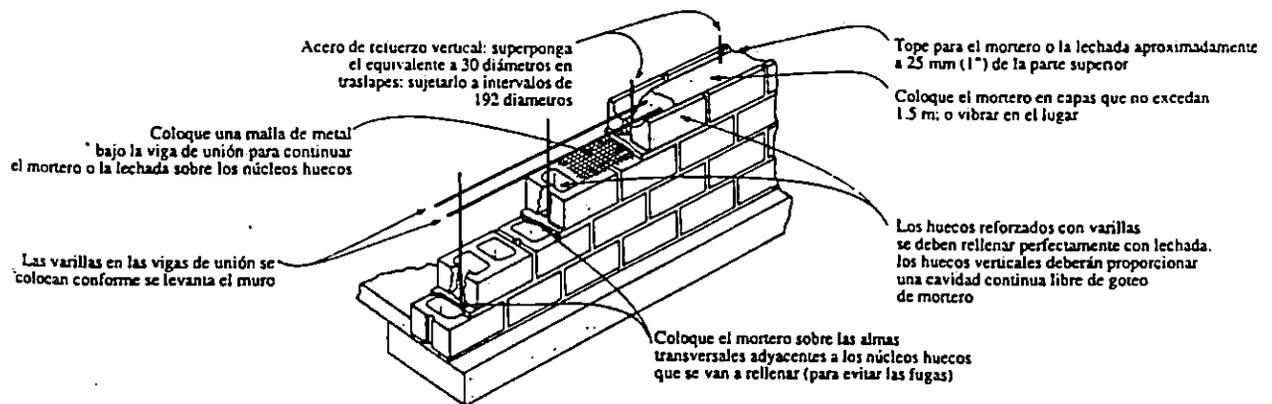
Aplicación de Lechada a poca altura en un muro de mampostería reforzada
